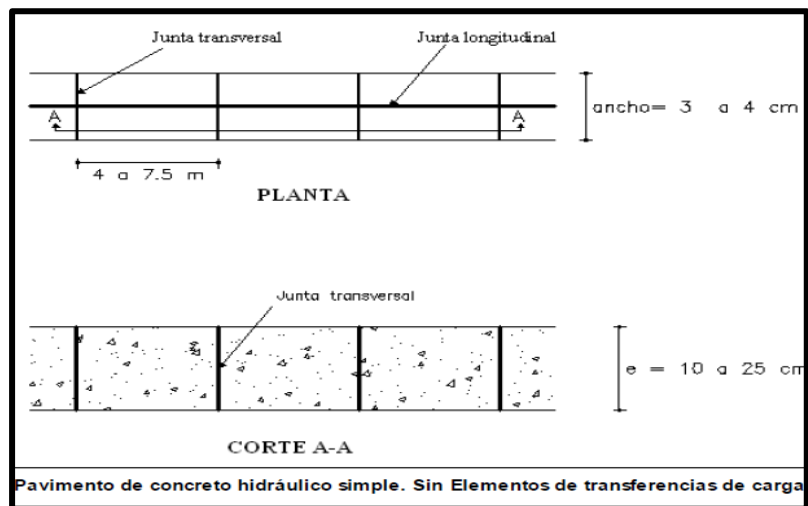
; Sección de Pavimento de Concreto Hidráulico sin Pasadores
